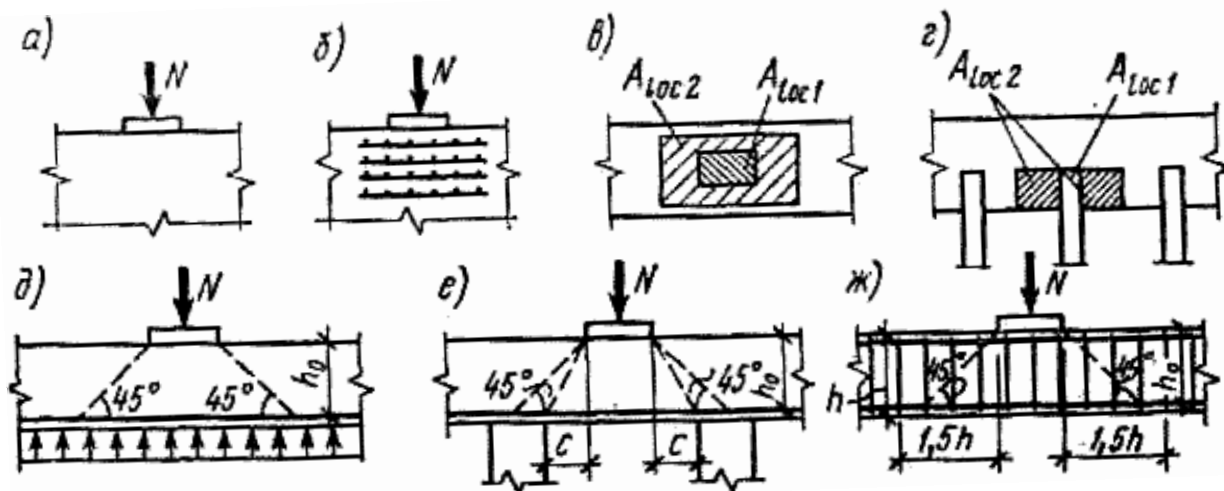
К расчету железобетонных элементов на местное действие нагрузок
